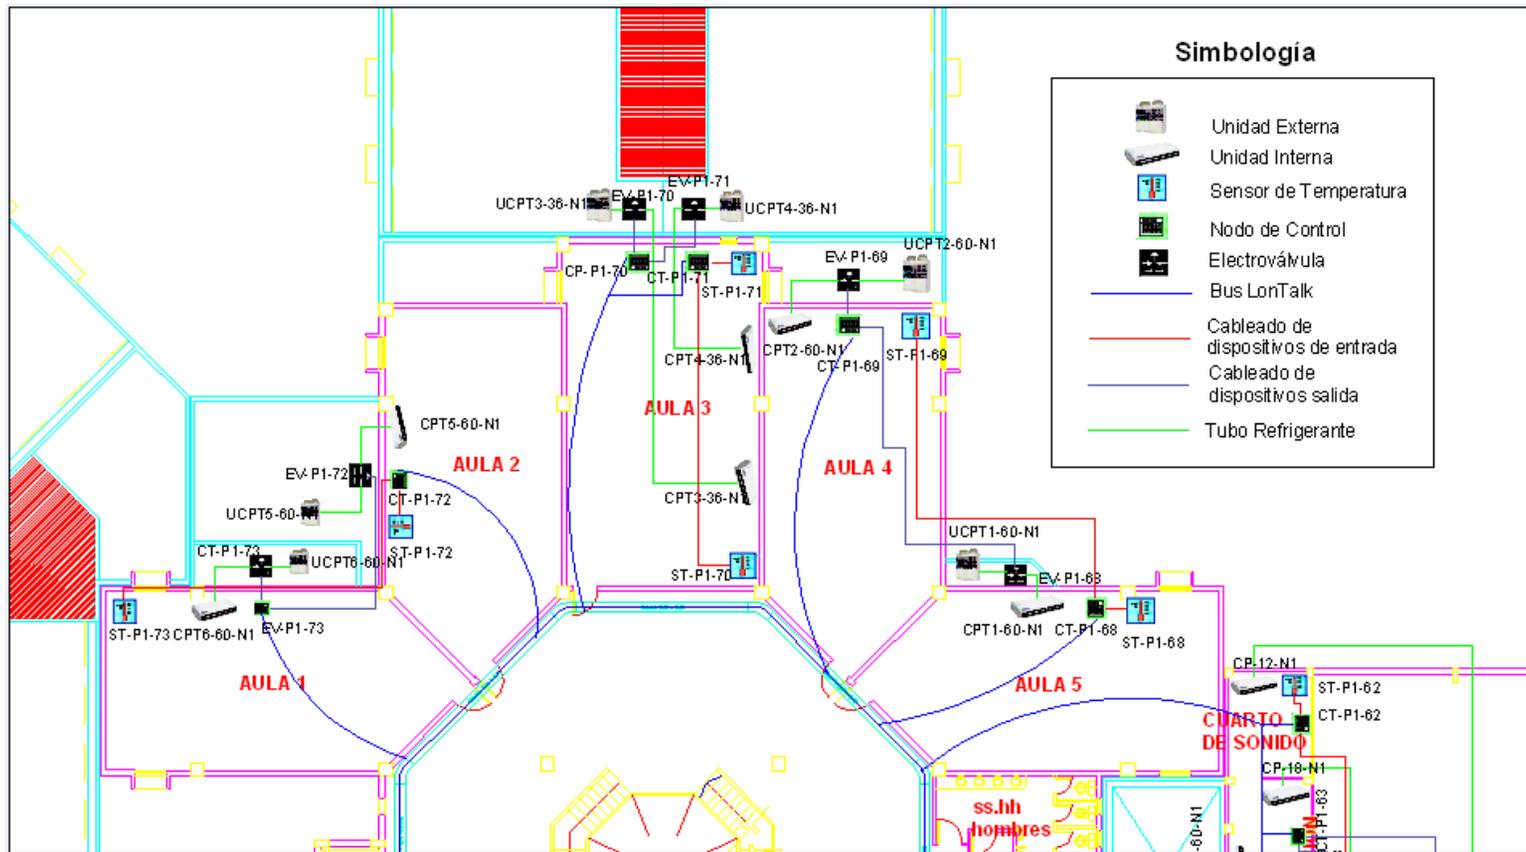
PLANO CLIMATIZACIÓN PRIMER PISO SECCION 1
